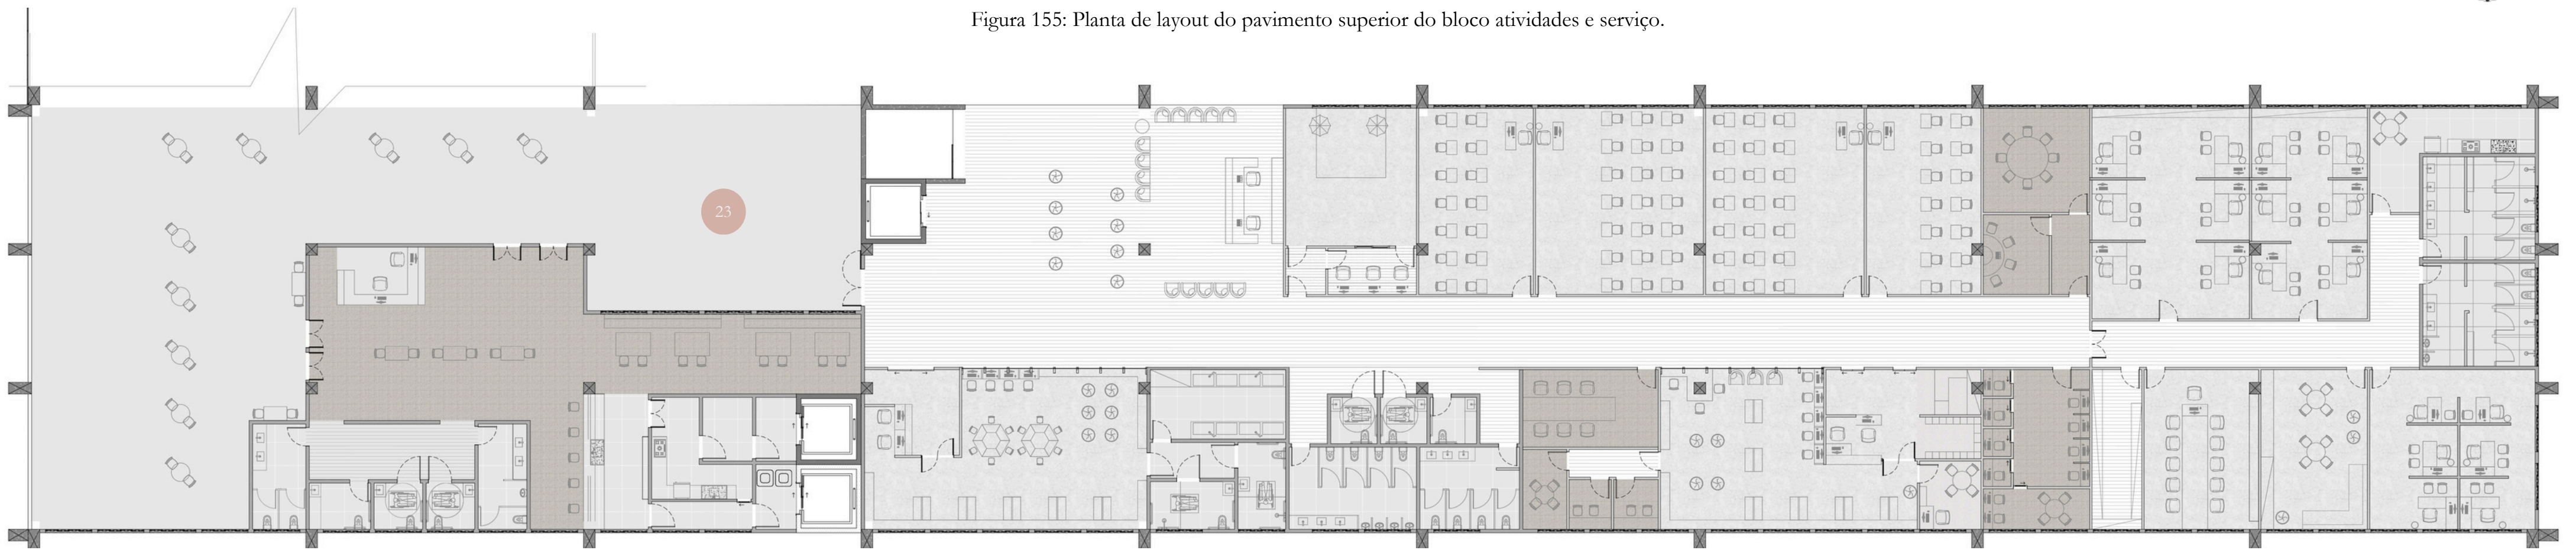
Planta de layout do pavimento superior do bloco atividades e serviço.
